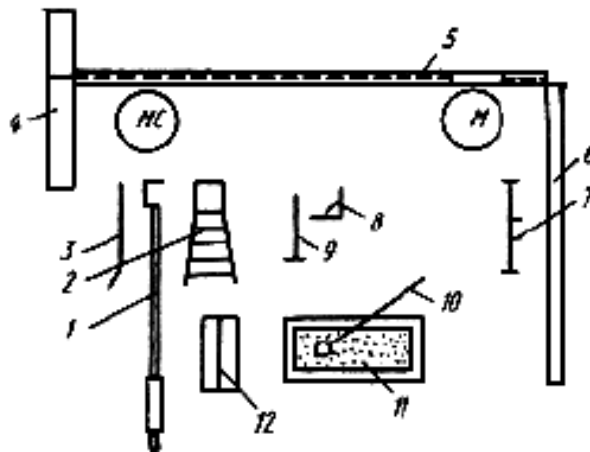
Схема организации рабочего места при монтаже панелей внутренних стен (перегородок):
